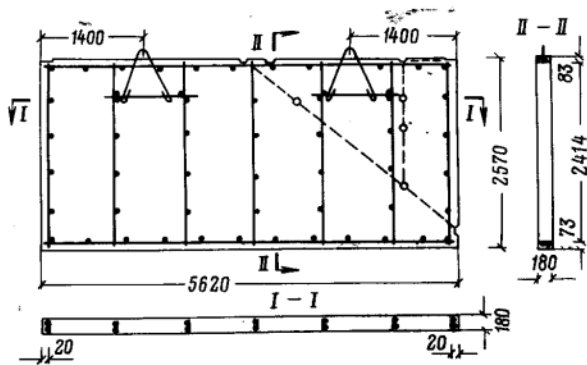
Схема армирования внутренней межквартирной стеновой панели
